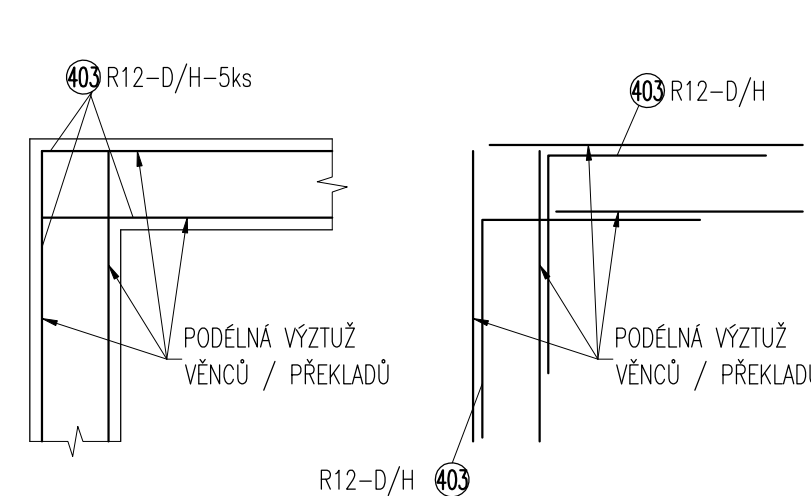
DETAIL KOTVENÍ ZÁVLAČNÝCH PRUTŮ V PLOŠE DESKY PŮDORYS M 1:25
